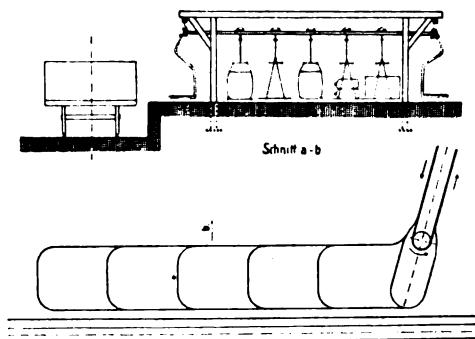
Schema Anfangsbahnhof mit Ladegleisen.
